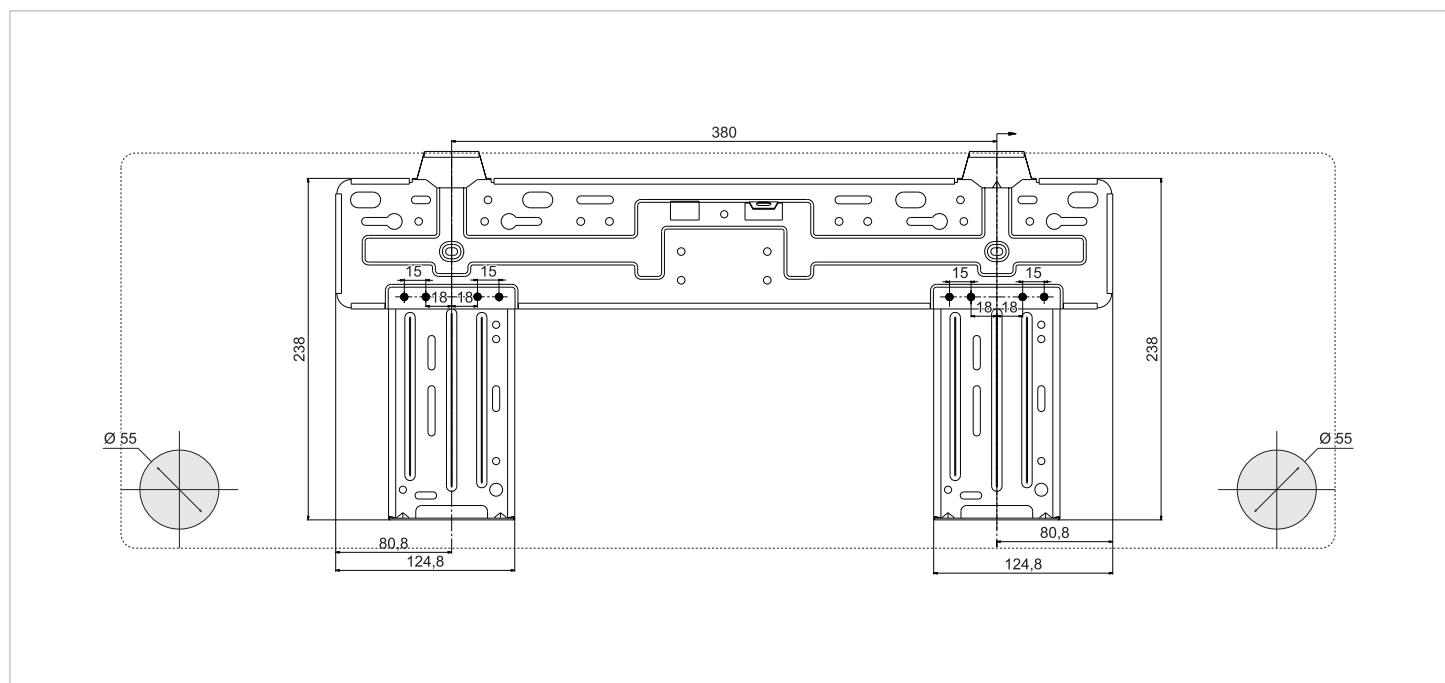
Placa de montagem para 17-035 NMWI.
